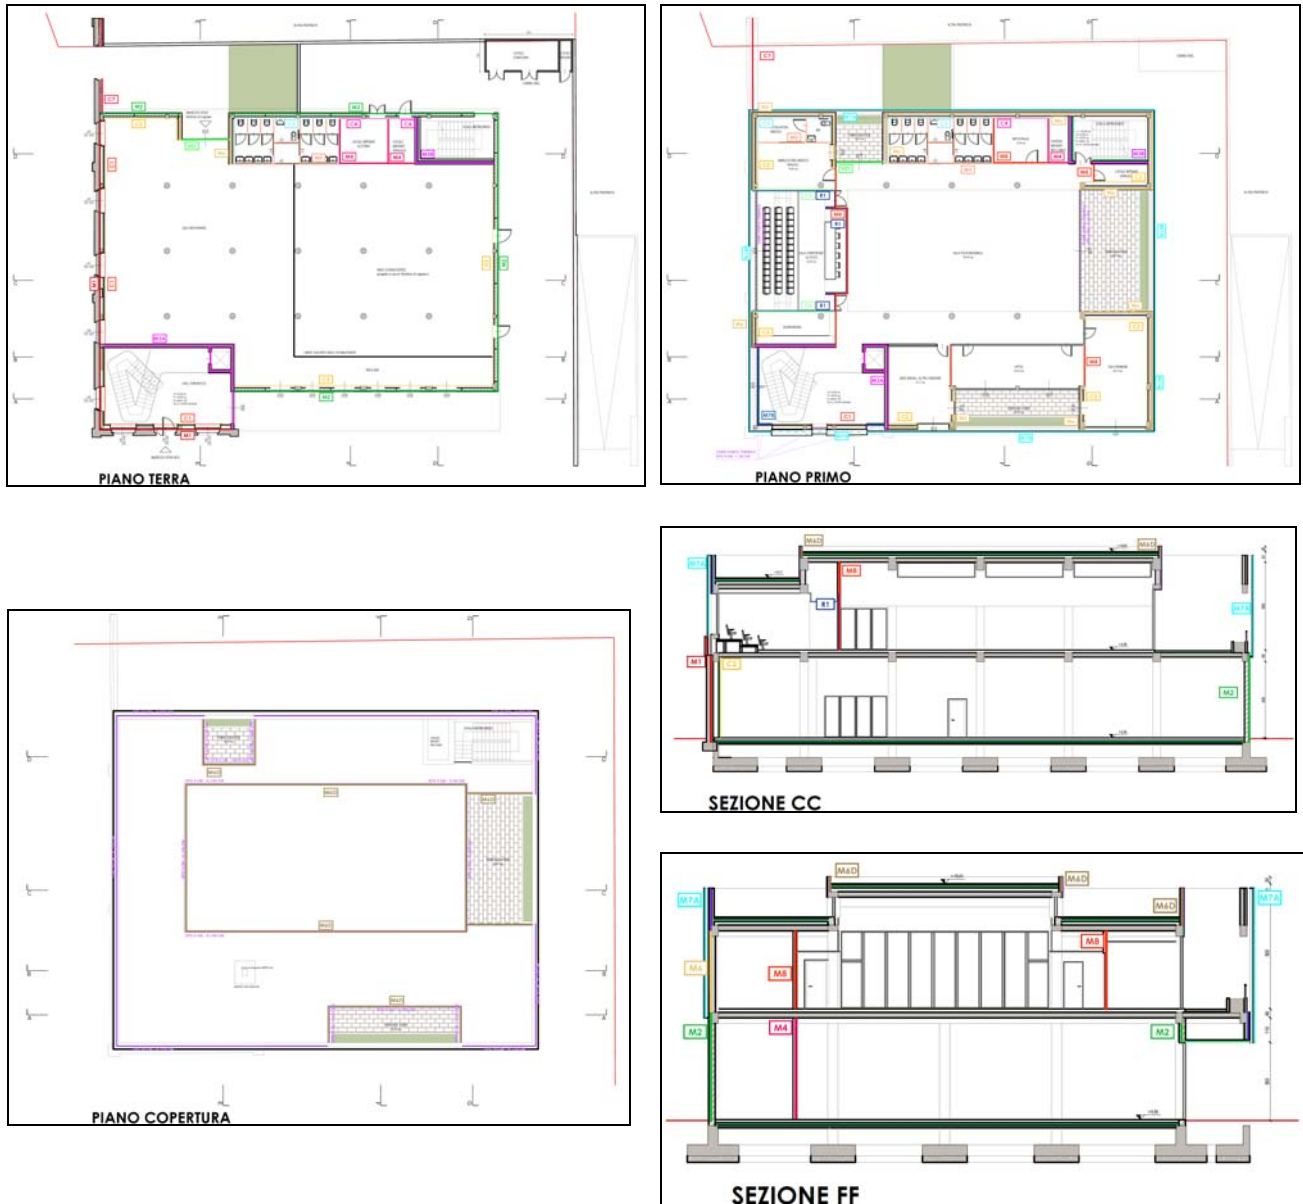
Prospetti e planimetrie indicative del progetto esecutivo
